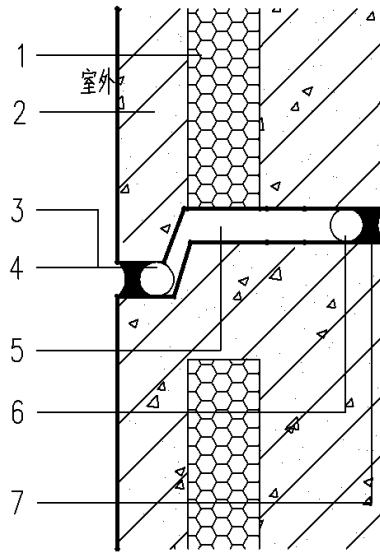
预制混凝夹心保温外挂墙板水平缝密封防水构造
